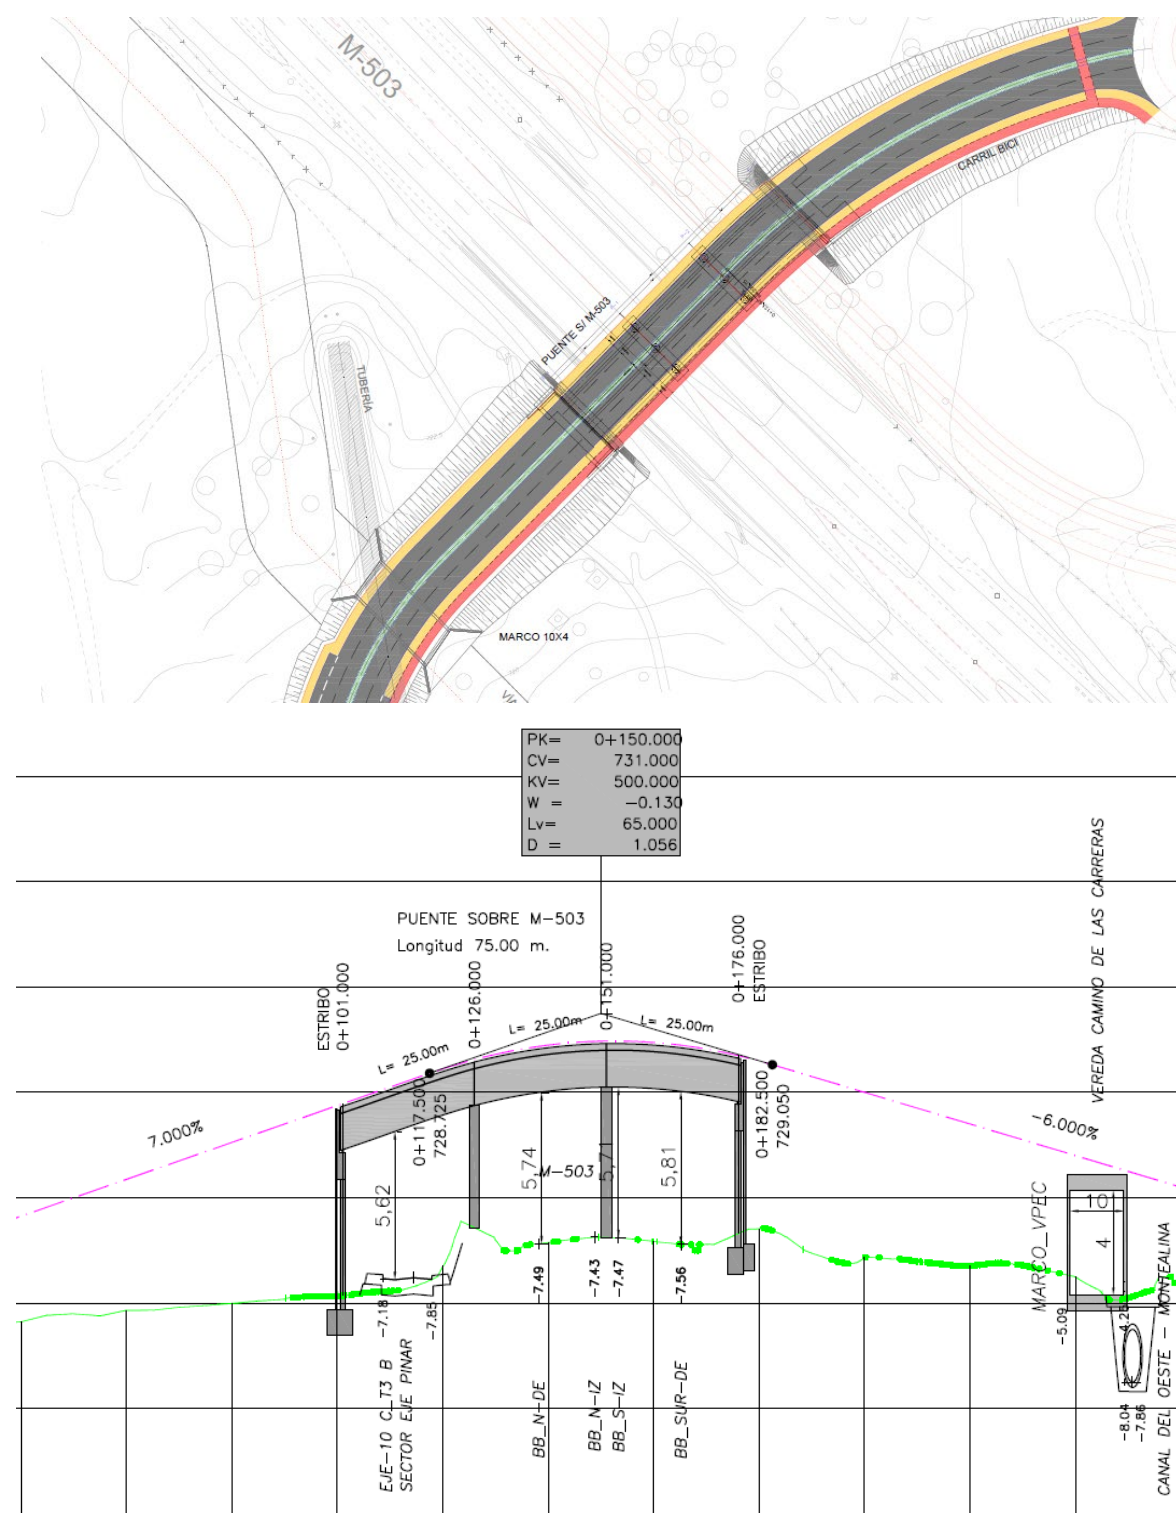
Perfil longitudinal ESTRUCTURA 6
